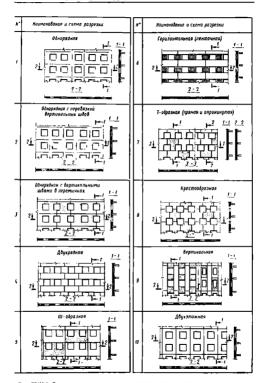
, Возможные схемы разрезки наружных стен на панели
